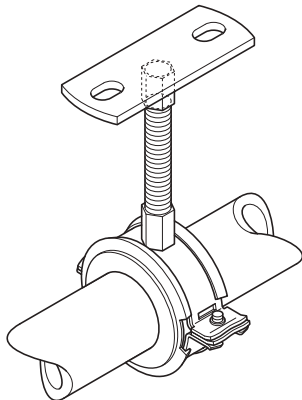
Fixação com Gola de braçadeira Geberit Mepla, diâmetro interno de 26 a 75 mm
